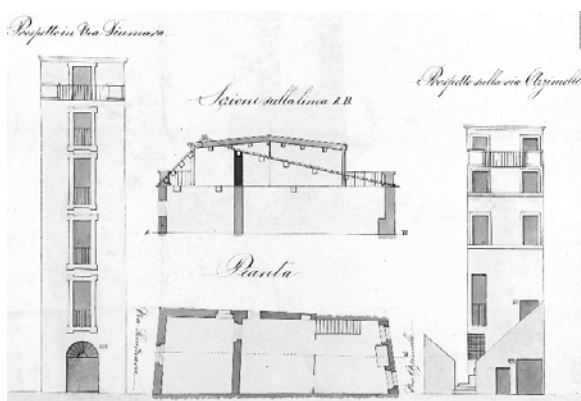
Progetto di sopraelevazione della casa a due prospetti, l'uno in via Fiumara n° 105, l'altro in via delle Azzimelle n° 84 e 87 (ASC, Titolo 54, prot. 72140, 1873)
